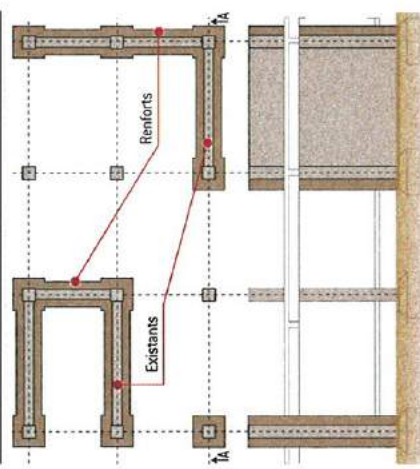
Exemple de renforcement de poteaux, murs, par chemisage en béton projeté (vue en plan et coupe AA)
